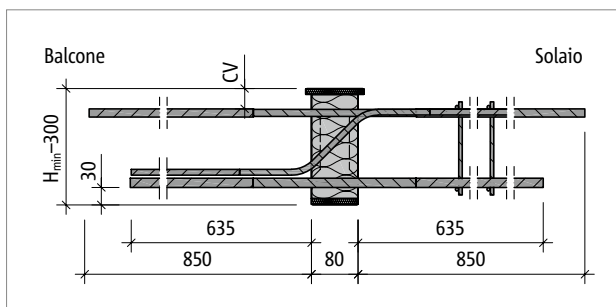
Schöck Isokorb® T tipo KP-M13 – M14-V1: sezione del prodotto
